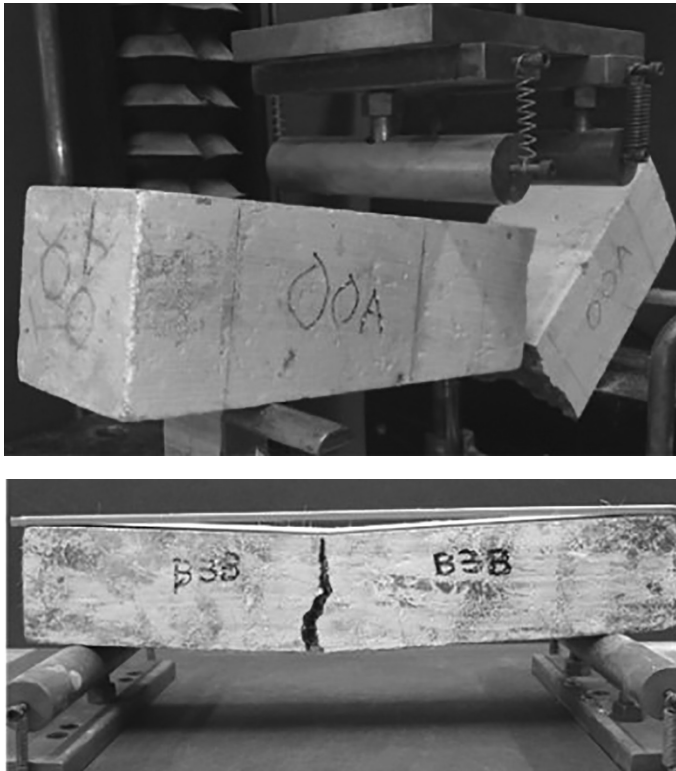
Rotura de las vigas: a) viga sin fibra de refuerzo;
